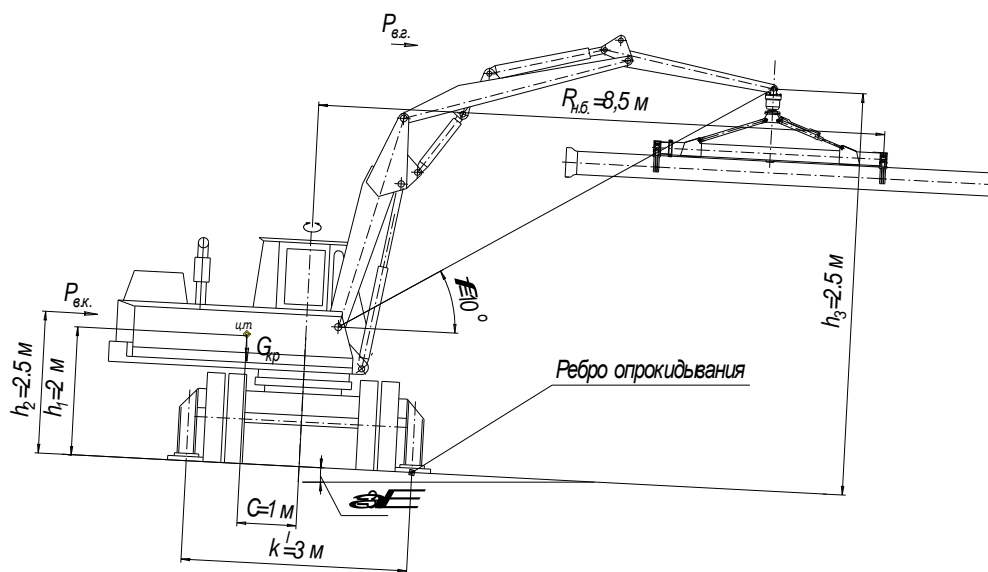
Общий вид и параметры многоцелевого манипулятора (в рабочем положении)
